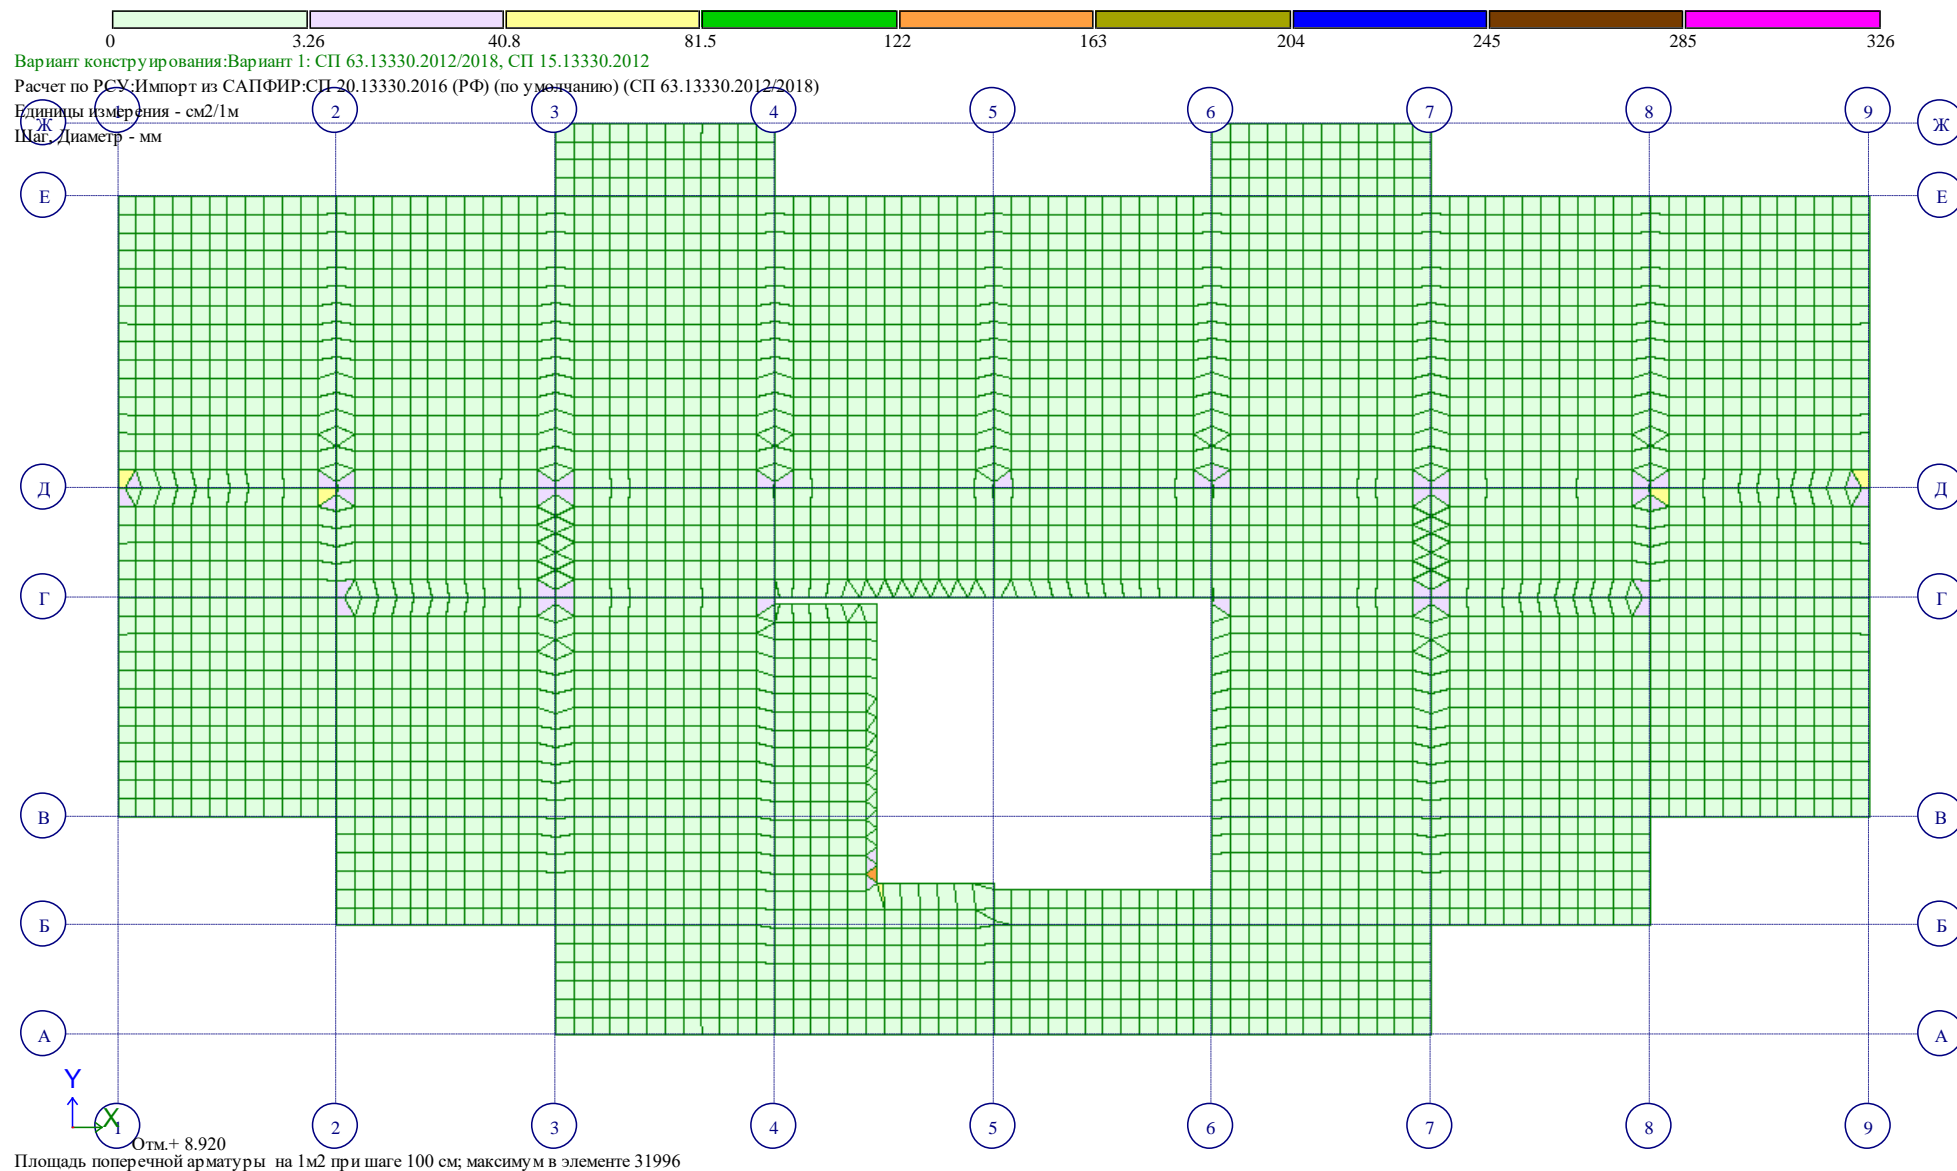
Площадь поперечной арматуры в см² на 1м²
